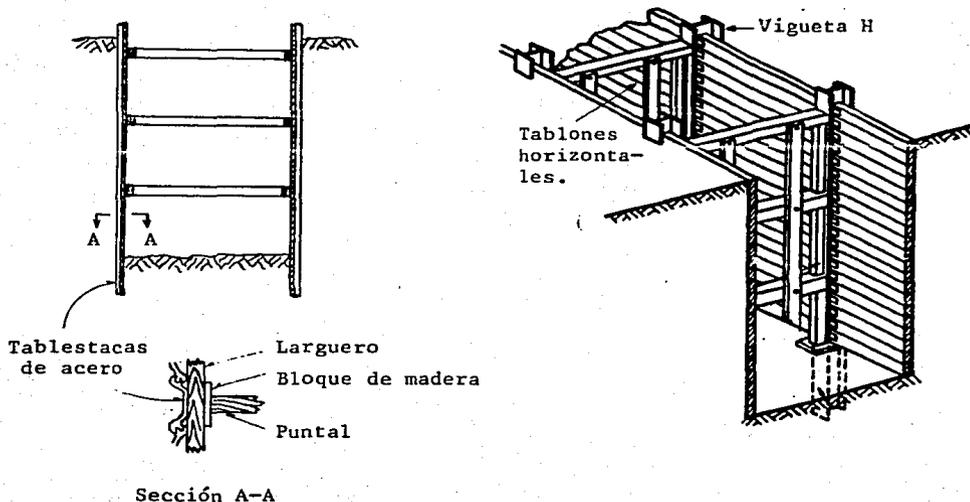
SECCIONES DE ADEME EN EXCAVACIONES.
